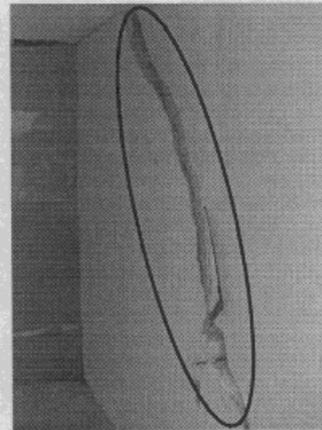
Agrietamiento y dislocación en el muro de cerramiento que limita los predios de las Señoras Moreno y Orozco.
